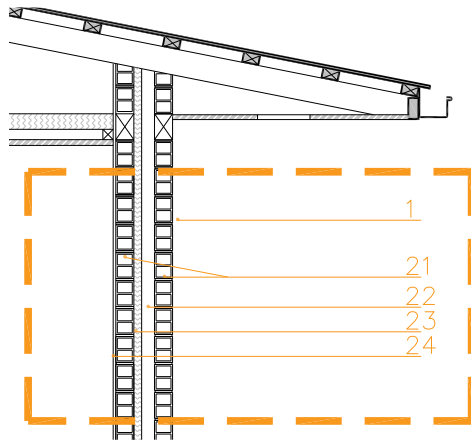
Diseño del muro perimetral con aislante térmico /planta
